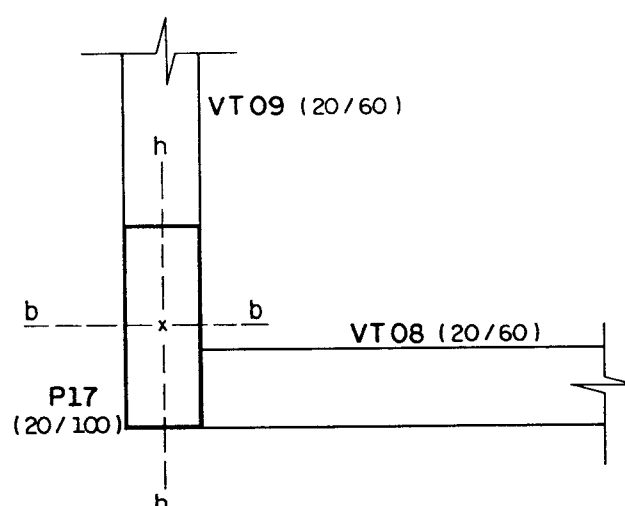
Ligações do pilar de canto P17 com as vigas VT08 e VT09
